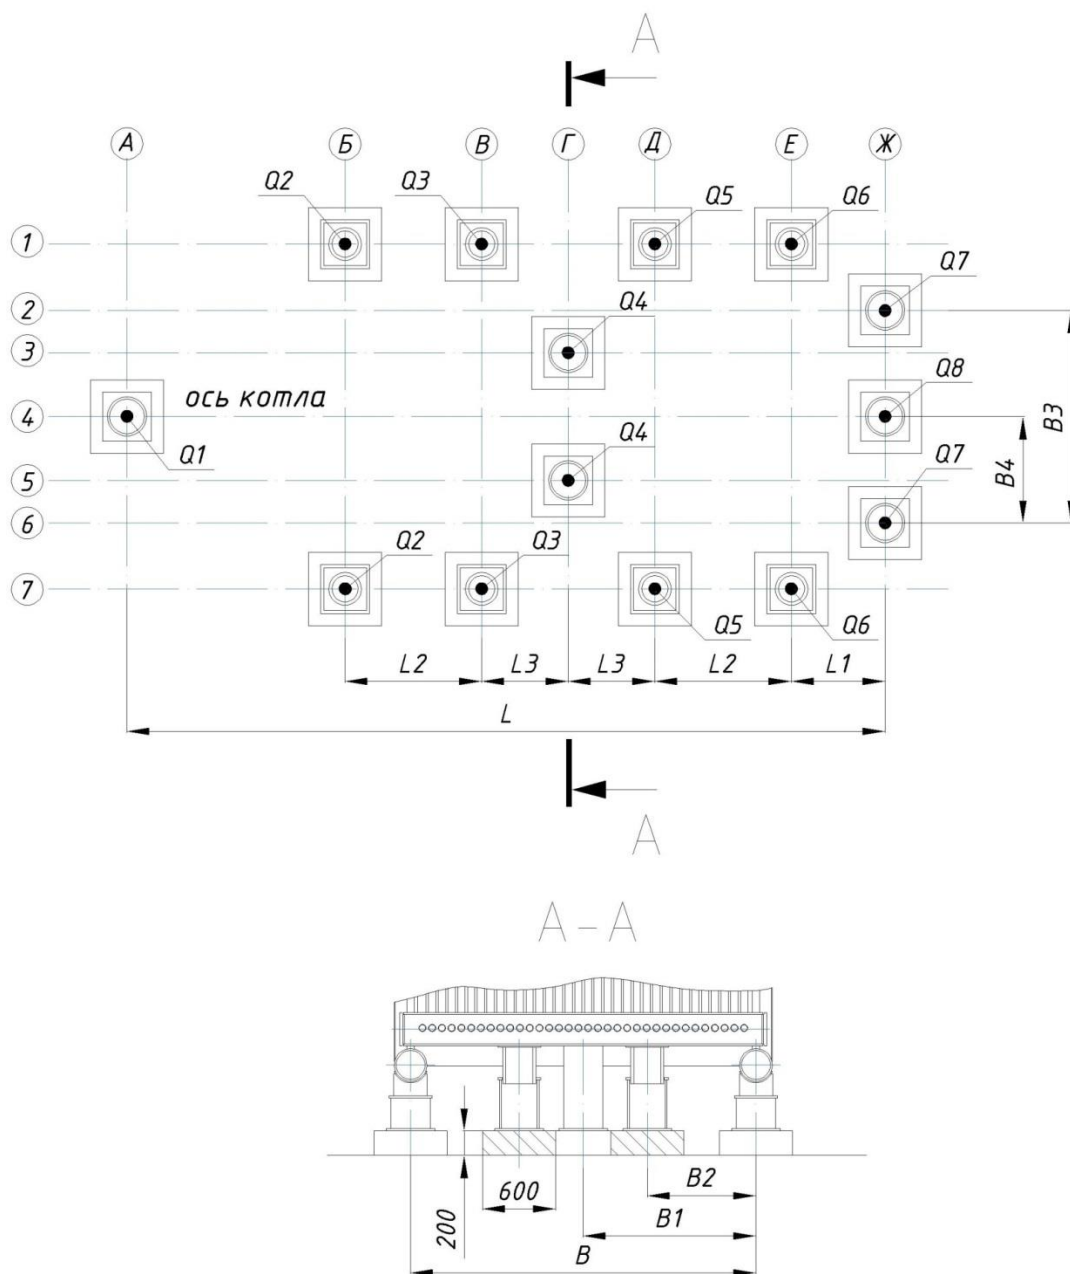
Схематическое изображение нагрузок на фундамент
